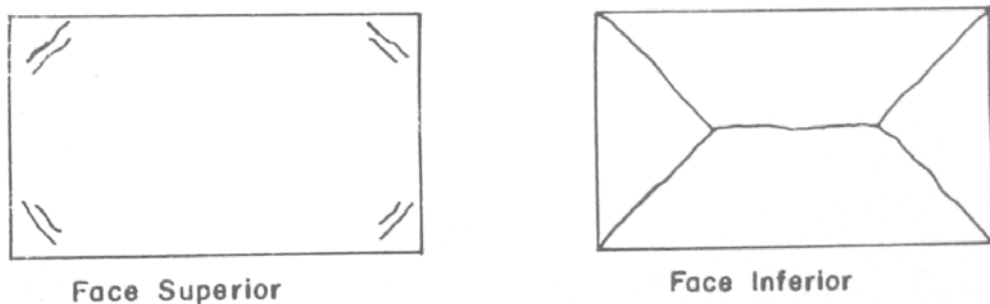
Fissuramento típico de lajes simplesmente apoiadas. (Fonte: THOMAZ)
